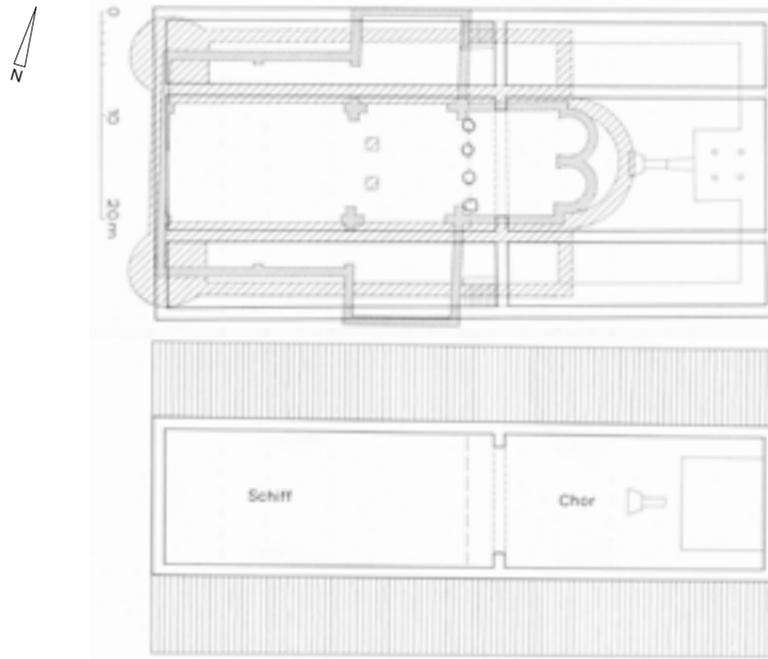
Erster veröffentlichter schematischer Grundriss der erfassten Mauerzüge (rot: Gozbertkirche). Publiziert durch Walter Horn und Ernest Born nach Vorlage von Hans Rudolf Sennhauser, 1979.
